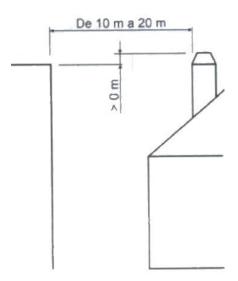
Distanza tra la finitura e oggetti tra 10 e 20 m
